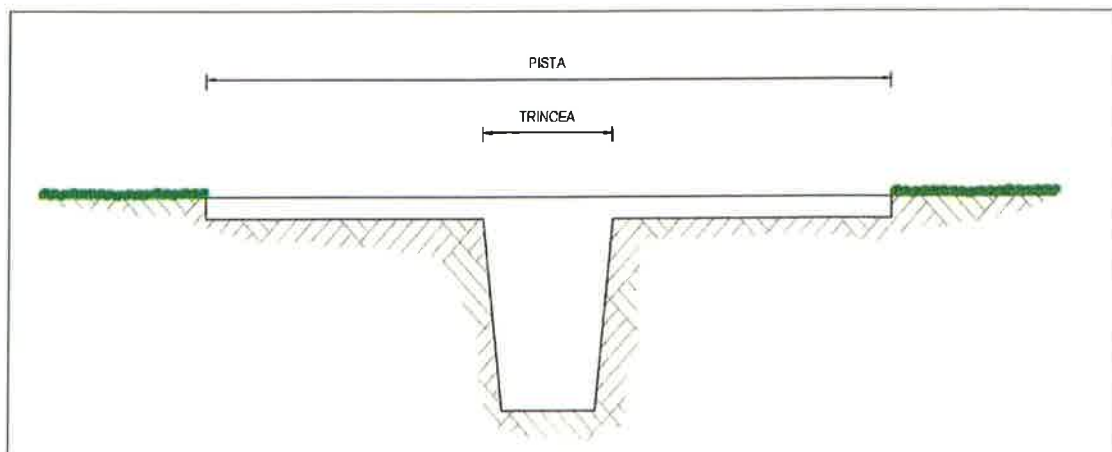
Schema Illustrativo delle Piste e Trincee
